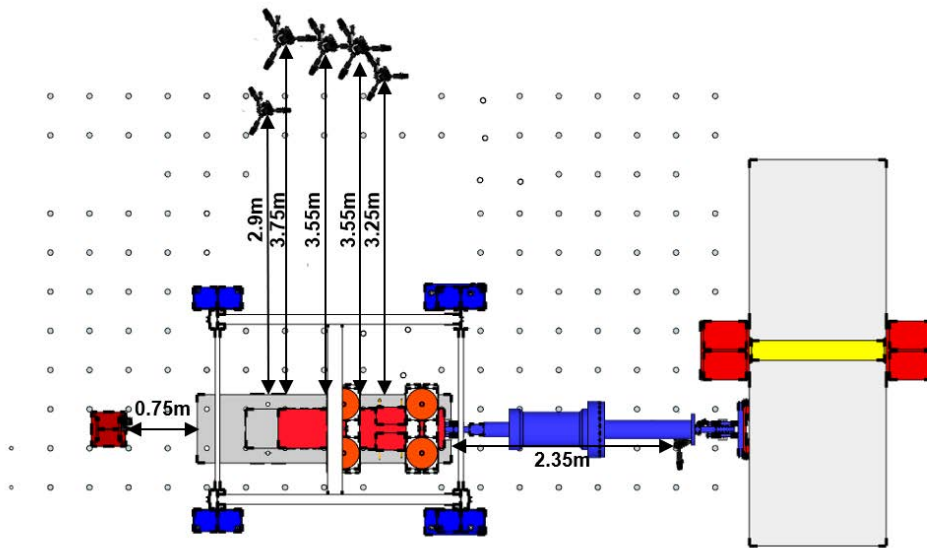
Distancia entre Cámaras y Probeta. Vista en Planta.
